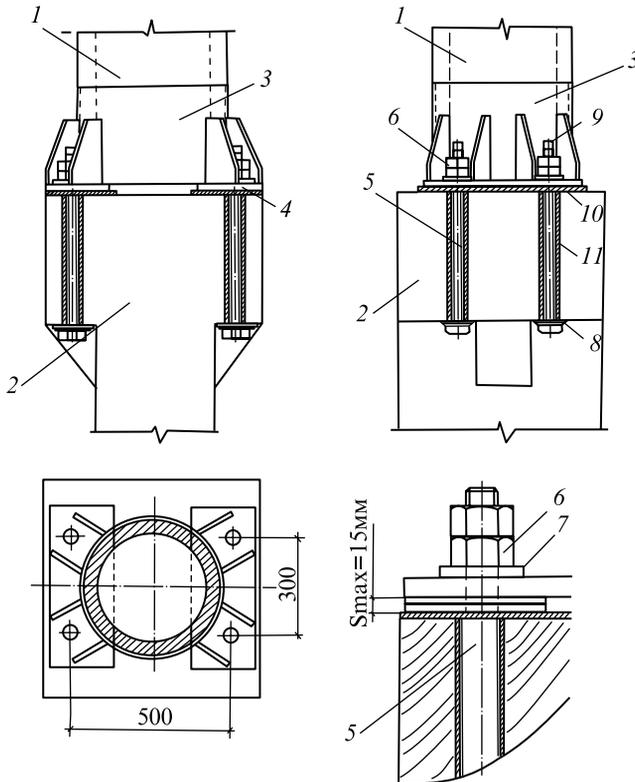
Узел крепления стойки к фундаменту: 1 — стойка; 2 — фундамент; 3 — стальное опорное кольцо; 4 — опорная пластина; 5 — анкерный болт (шпилька); 6 — гайка М-36; 7 и 8 — шайба регулировочная и изолирующая; 9 — колпачок изолирующий; 10 и 11 — изолирующие пластина и втулка
